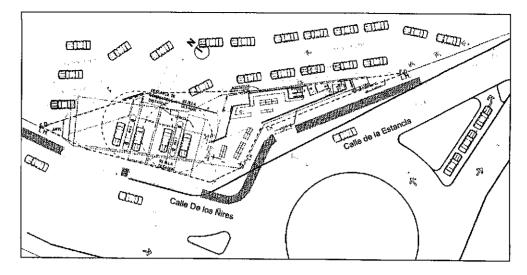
Planta-Anteproyecto Estación de Servicio (ver plano en el anexo)
